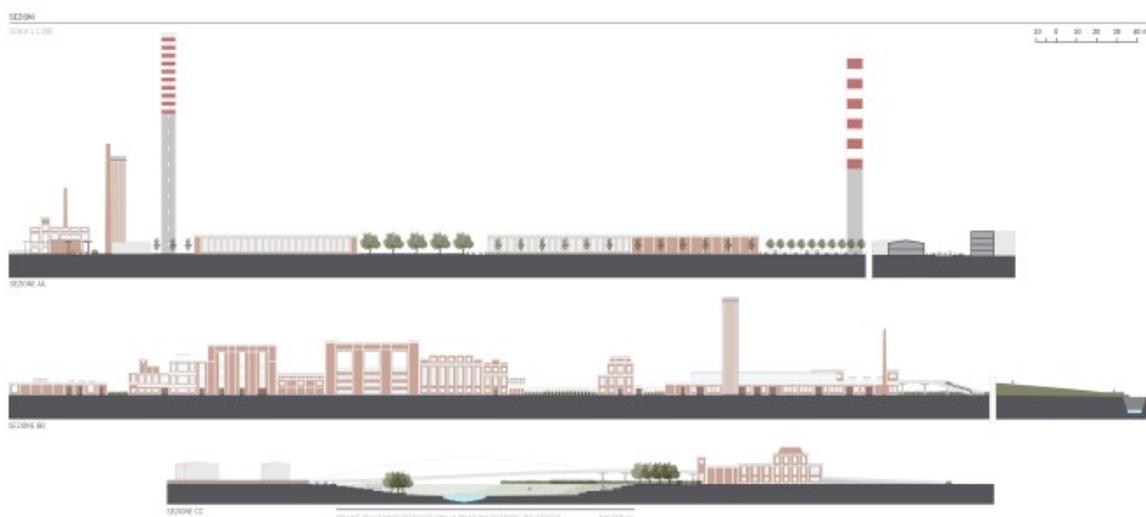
| Prospetti e sezioni area ex Snia – Varedo. Fonte: Gruppo 1 – Tav. 5.
